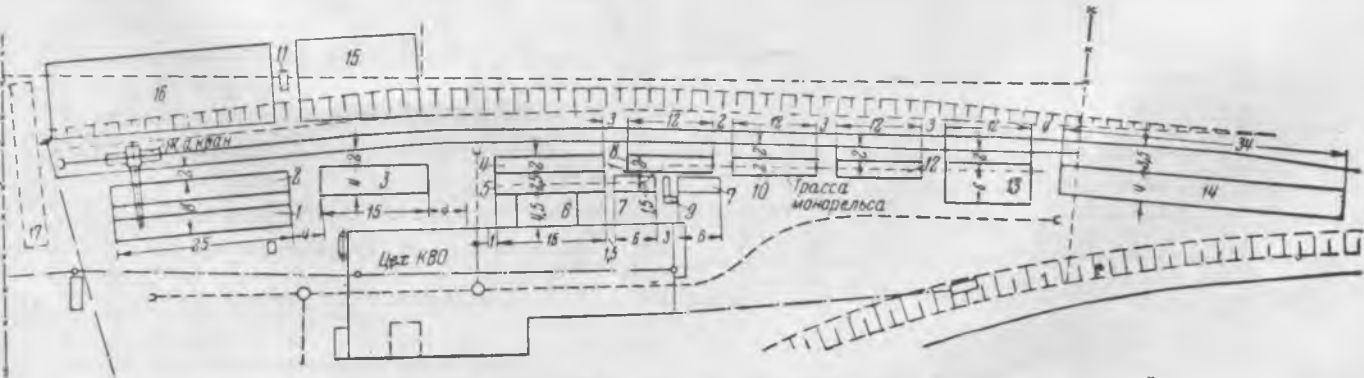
Расположение стеллажей и складов для изготовления металлоконструкций.
